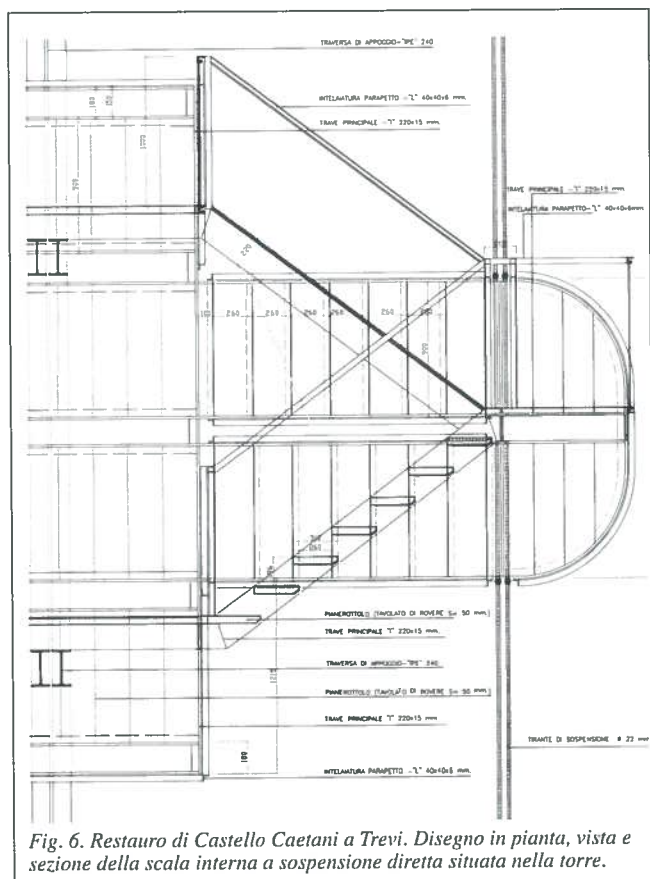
Restauro di Castello Caetani a Trevi. Disegno in pianta, vista e sezione della scala interna a sospensione diretta situata nella torre.
